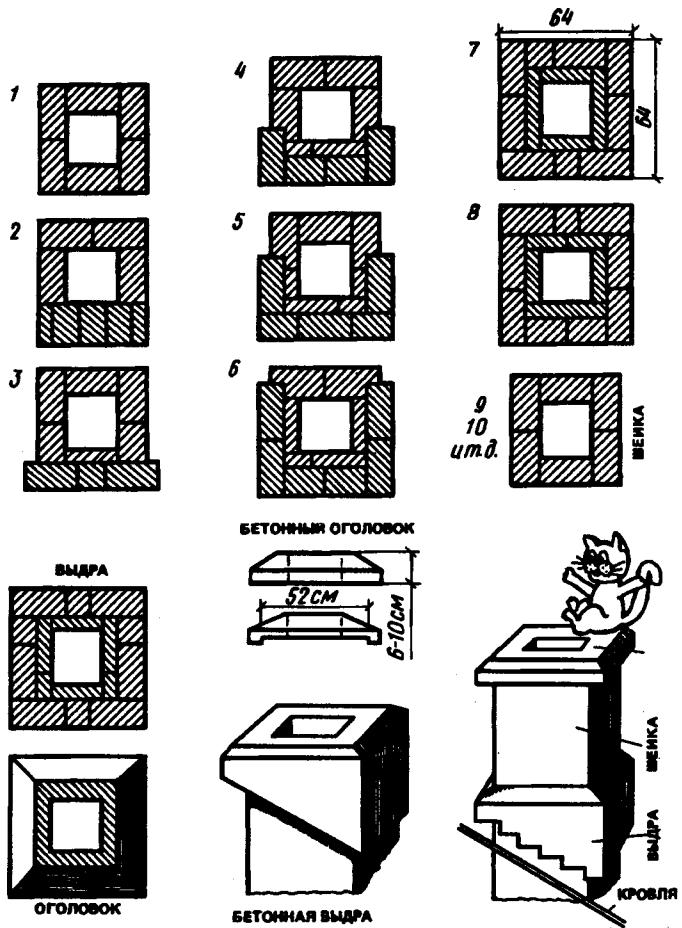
Кладка выдры, шейки и оголовка трубы
